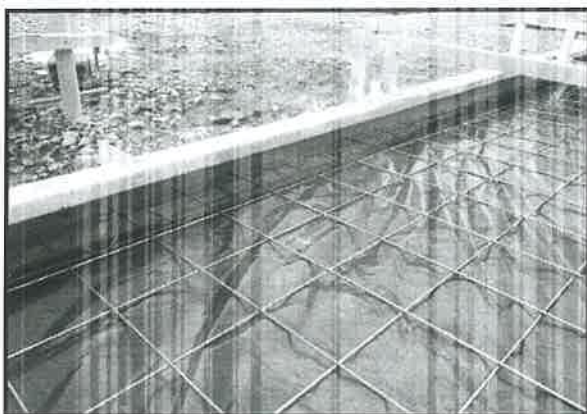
Armadura do radier (treliça e tela soldada)
